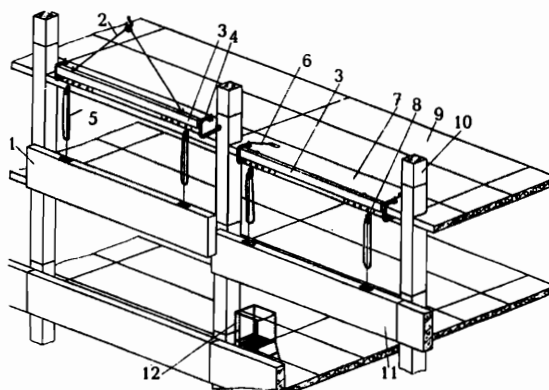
Установка панелей стен при помощи траверсы с поддерживающими приспособлениями конструкции ЦНИИОМТП: 1 – рядовая панель стены в процессе установки; 2 – двухветвевой строп; 3 – траверса; 4 – поворотный захват; 5 – поддерживающее приспособление; 6 – предохранительный цепной строп; 7 – связевая таль; 8 – рядовая плита перекрытия; 9 – рядовая плита перекрытия; 10 – колонна; 11 – рядовая панель в процессе выверки в проектное положение; 12 – монтажная площадка
